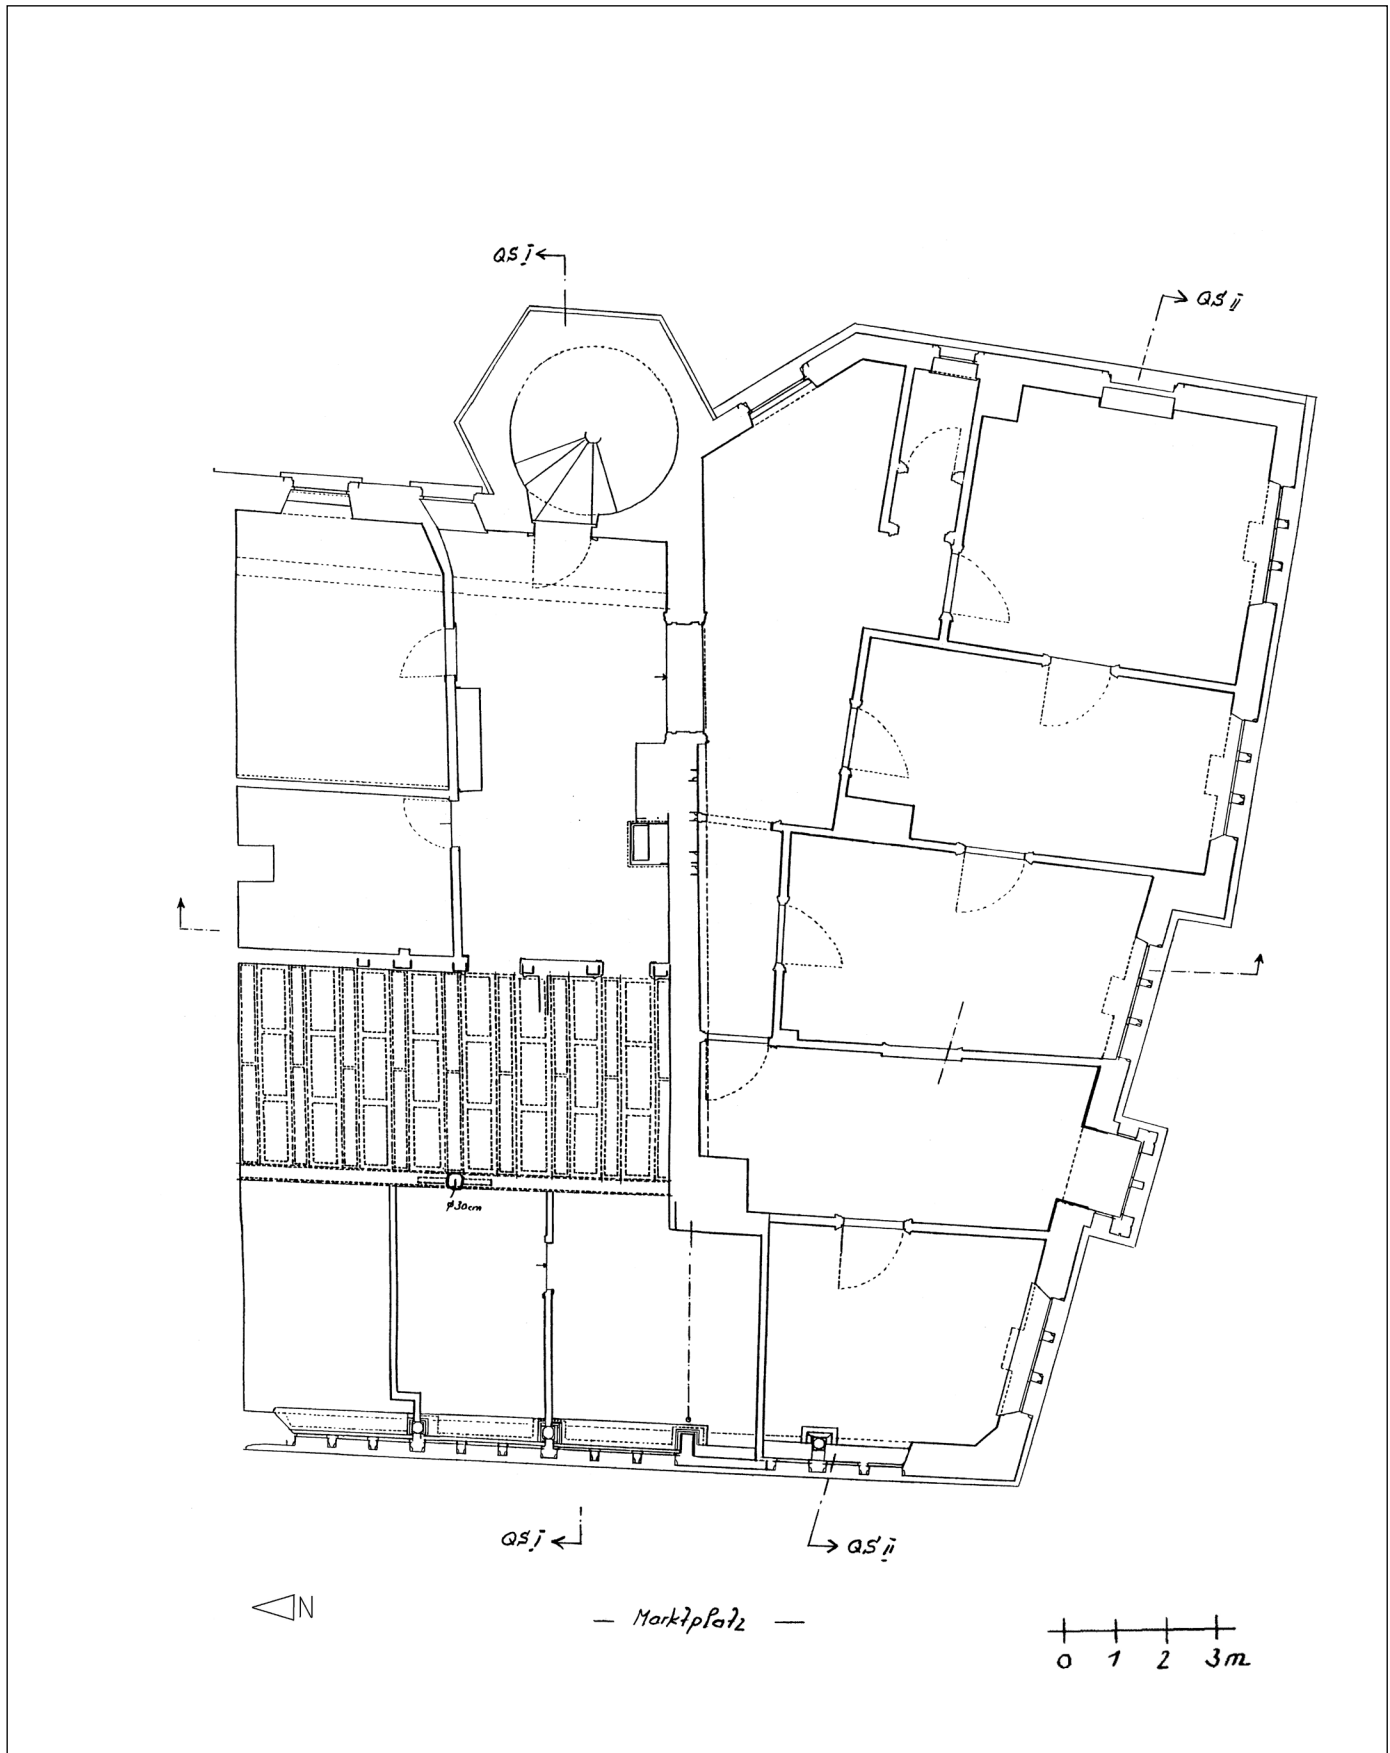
Hauptstraße 53, Rathaus, Grundriss 2. Obergeschoss, M. 1:150.
